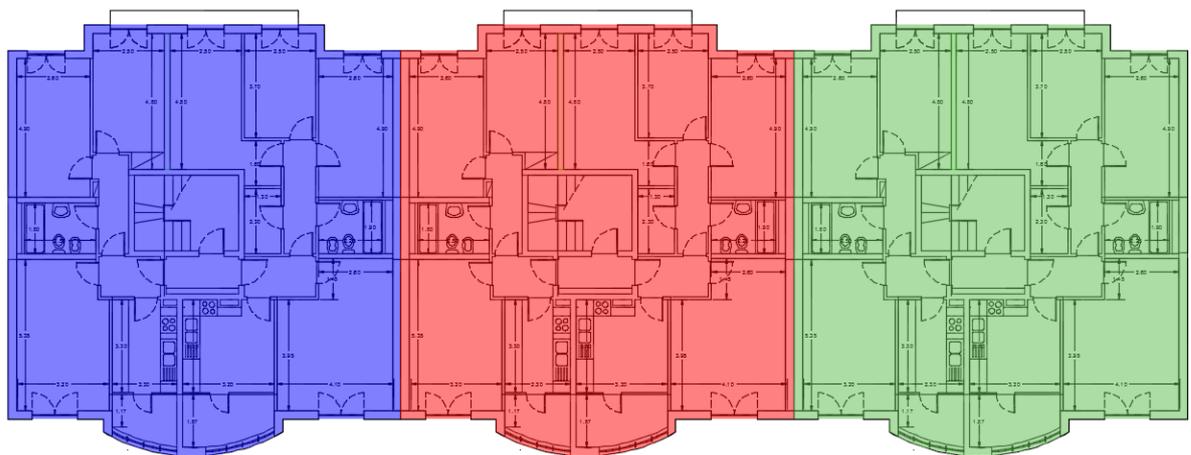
Planta do piso 1 e 2 do caso de estudo (Azul – Bloco A; Vermelho – Bloco B; Verde – Bloco C)
